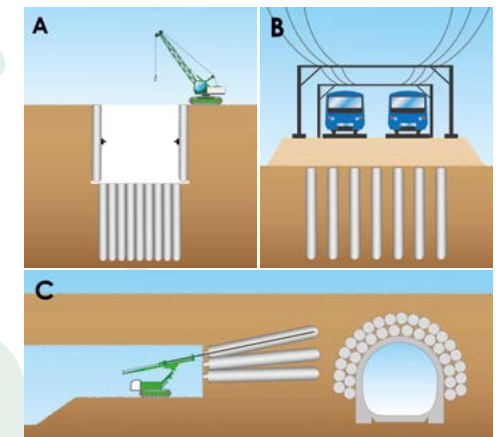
Algumas aplicações típicas de jet-grouting. a) suporte de escavação e plug de vedação, b) fundação de aterros, c) pré-suporte de túneis (Croce et al, 2014)
